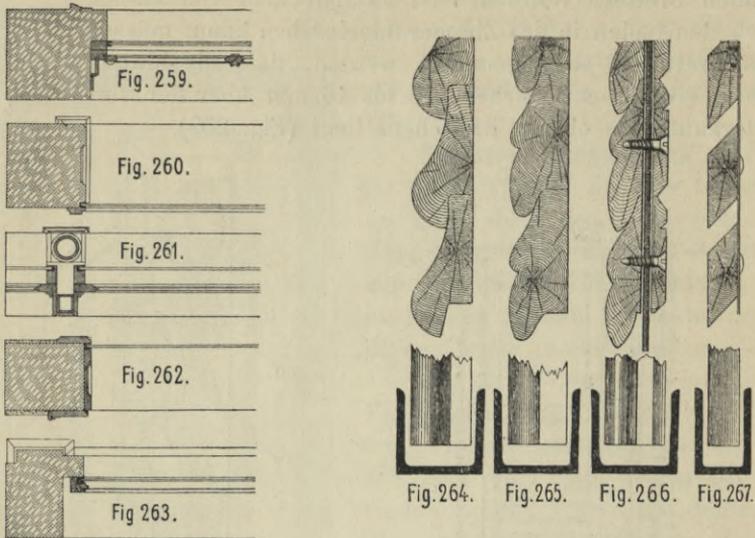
zeigt eine feststehende Rolljalousie aus Prismastäben auf Stahlbändern. Die Fig. 268 und 269 geben dieselbe Konstruktion, aber mit verstellbaren Stäben.
